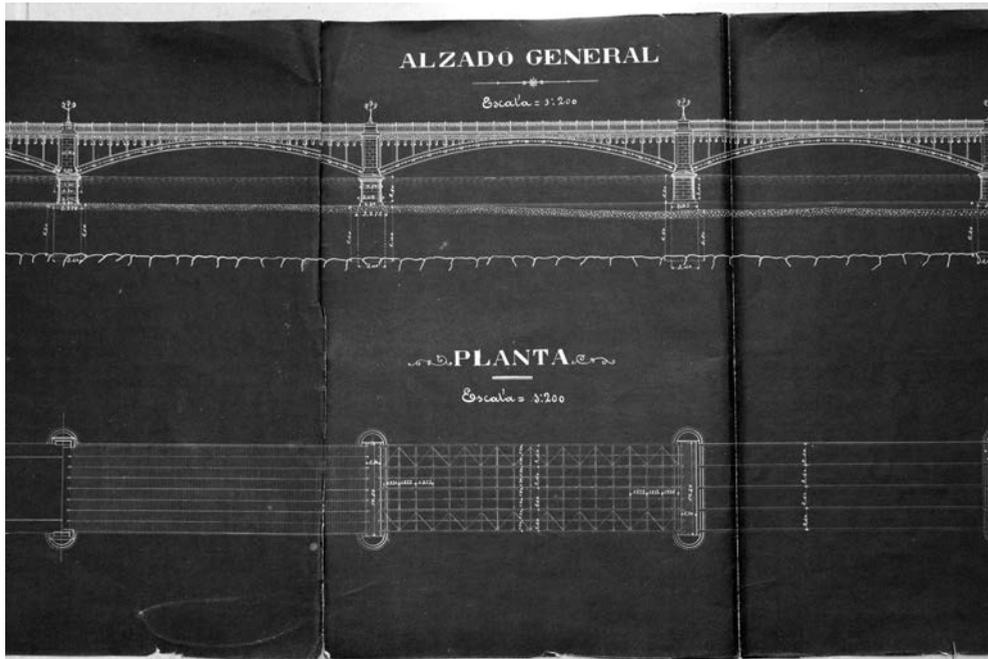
Detalle del alzado y planta (Saturnino Zufiaurre, 1898)
